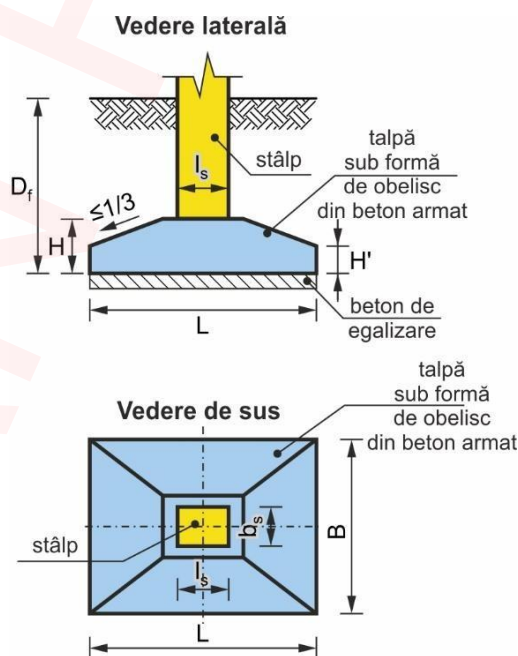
Fundație tip talpă din beton armat sub formă de obelisc
